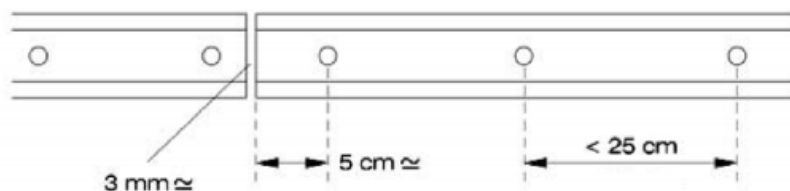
Detalle separación entre perfiles. Fuente Figura 29 Norma UNE 104416:2009
